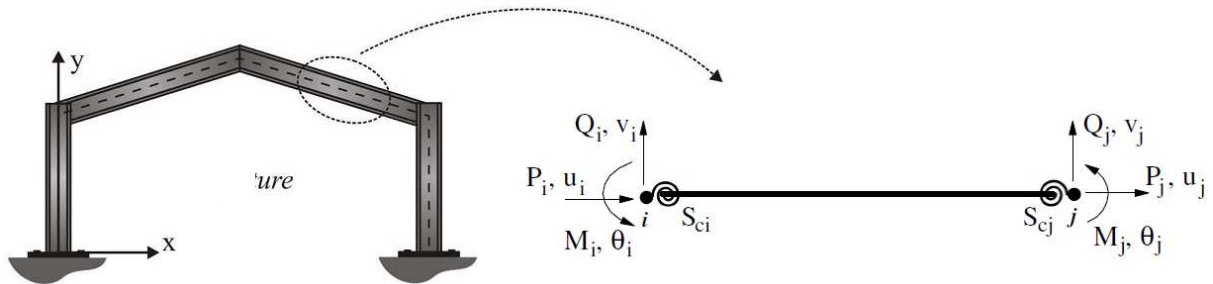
Elemento de pórtico plano com ligações semirrígidas
